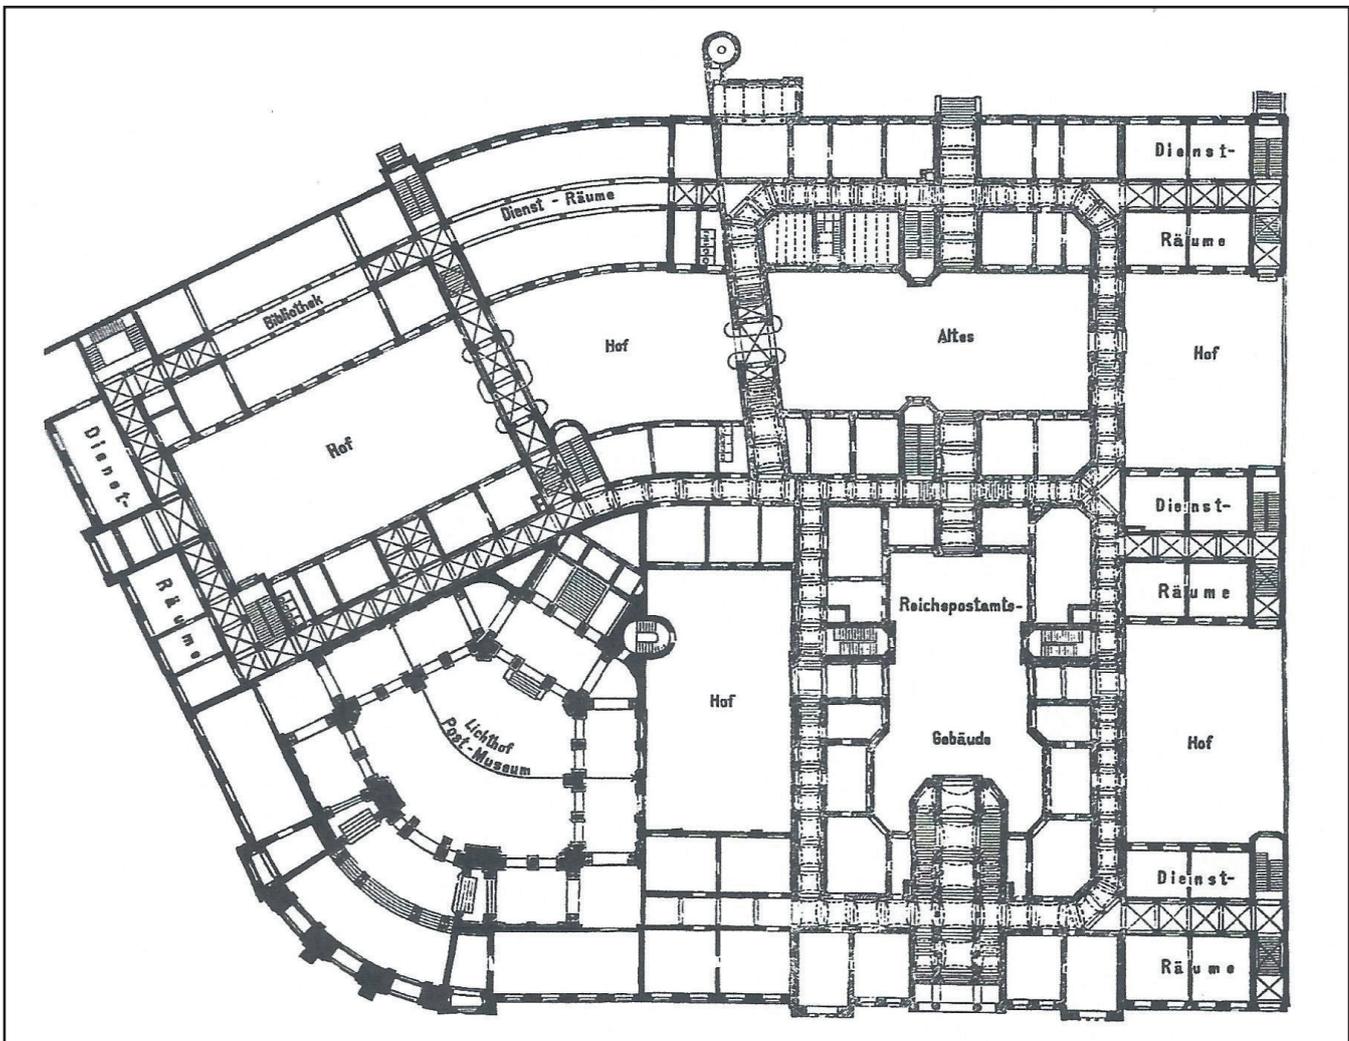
Grundriss des Erdgeschosses des Reichspostamtes und Reichspostmuseums, entnommen „Berlin und seine Bauten“, S. 27.
